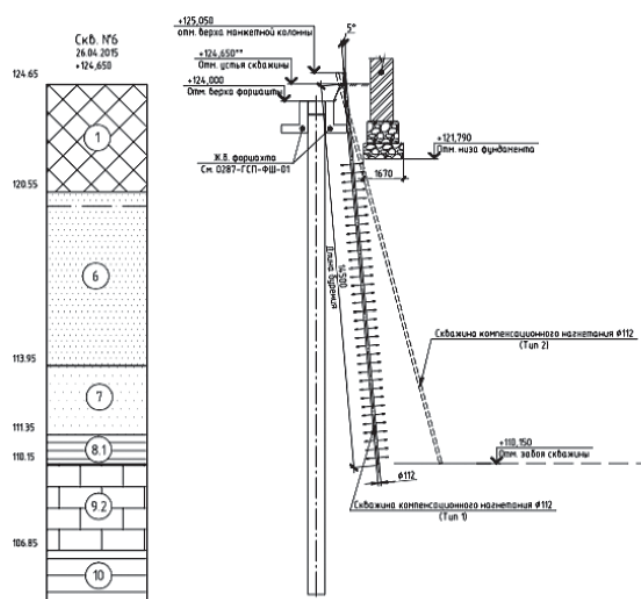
Схема выполнения работ по усилению грунтового основания фундаментов существующих зданий
